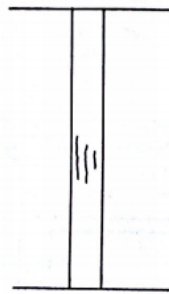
Fissuras verticais no pilar indicando insuficiência de estribos
